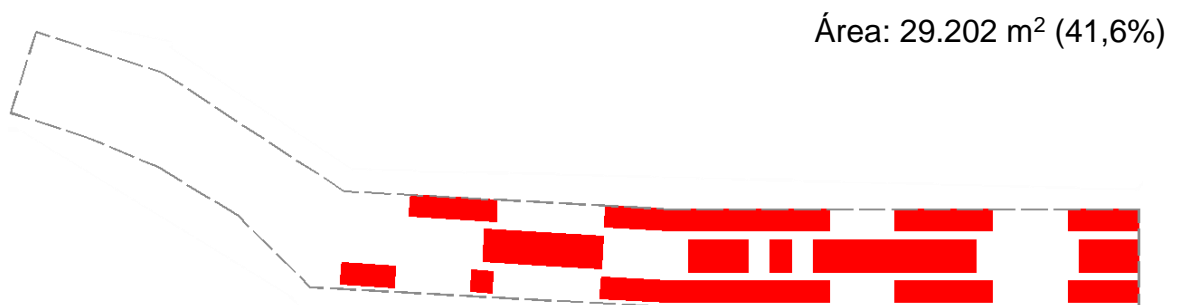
KELLY SALAZAR. Planta recorridos proyecto.
